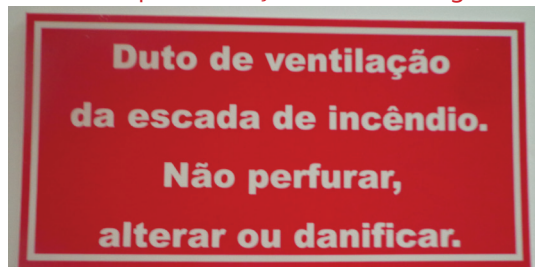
| Identificação do duto do sistema de pressurização da escada no teto do pavimento térreo
